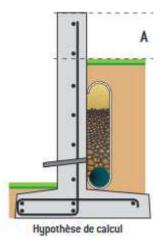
Exemple de drainage d'un mur de soutènement (source : qualiteconstruction.com)
